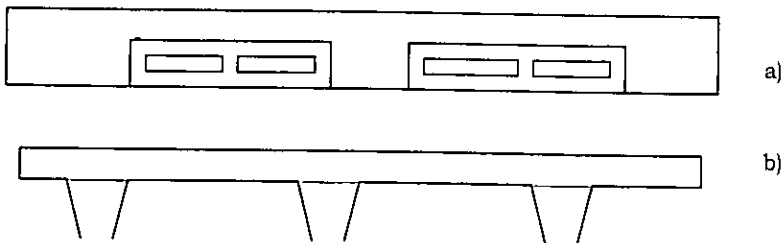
a) losa a partir de bloques huecos, b) losa con viguetas de concreto
